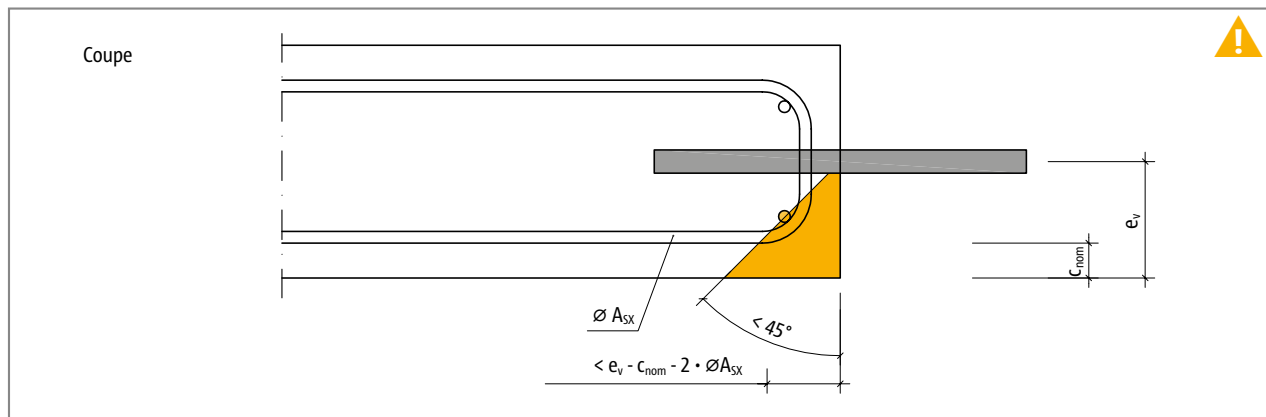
Schöck Dorn type LD : Position du ferrailage longitudinal en rapport avec la face de la dalle
